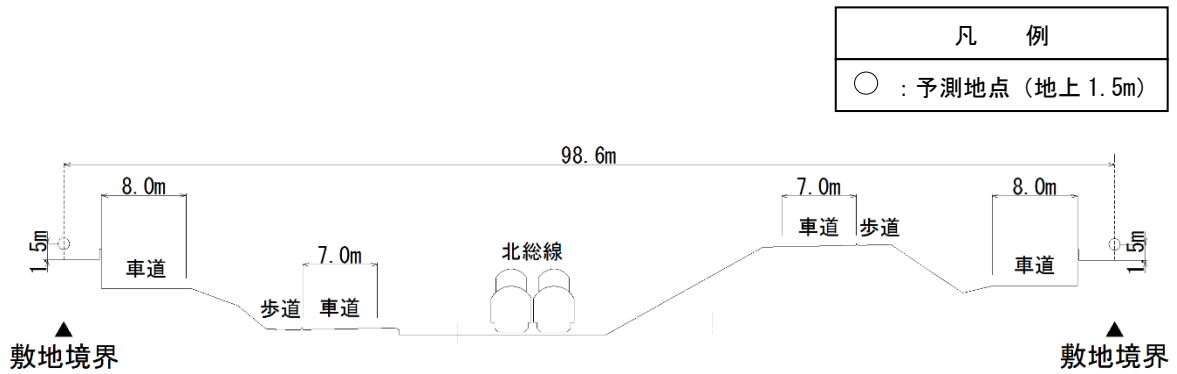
(8) 予測断面図 (H. 一般国道464号 (5))
